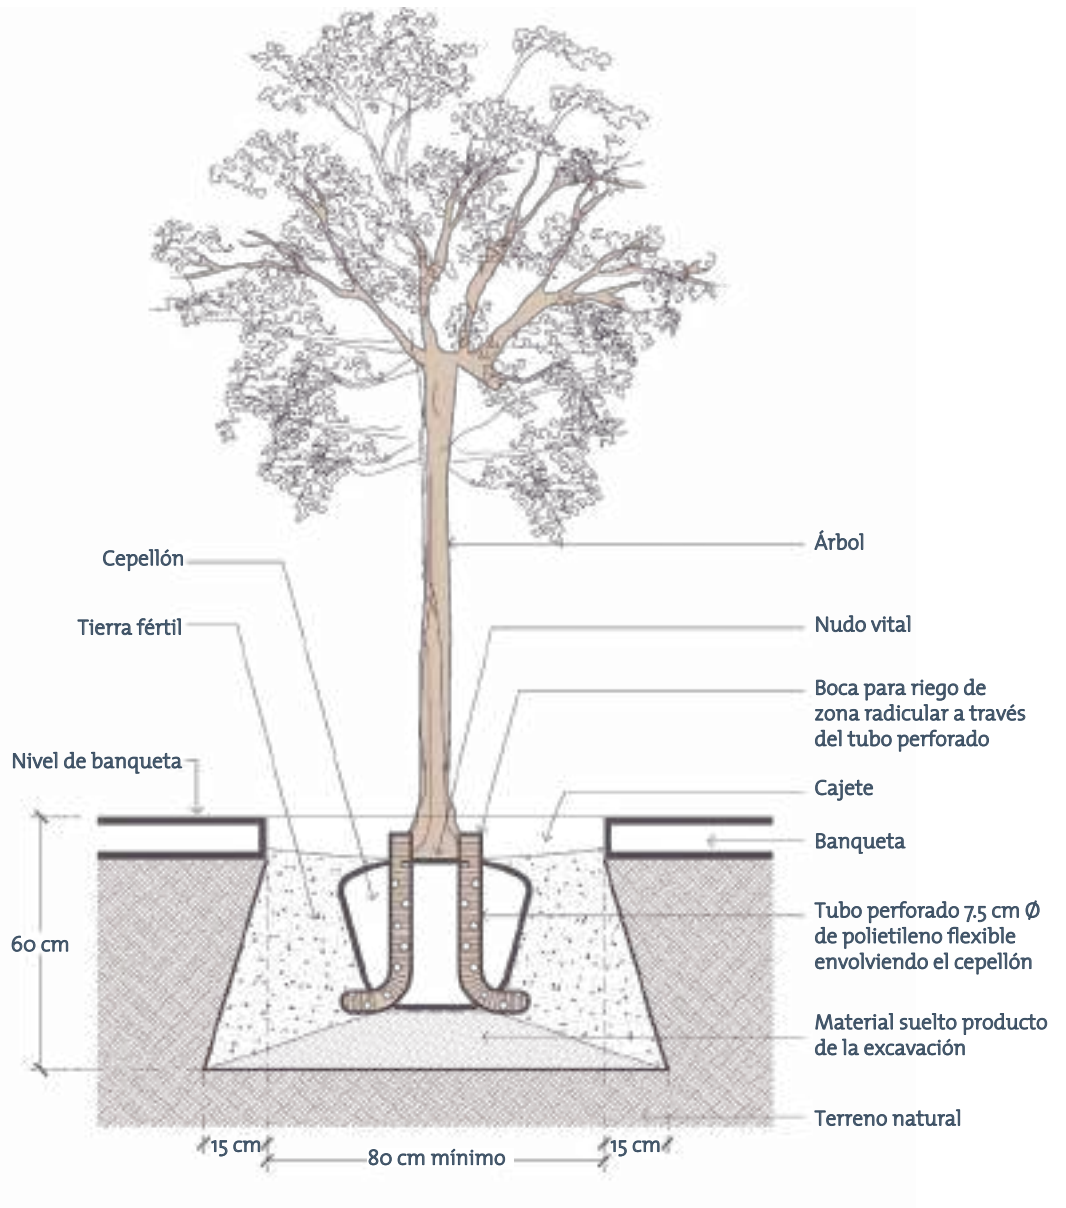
Riego de árboles en áreas pavimentadas mediante tubos o mangueras perforadas
